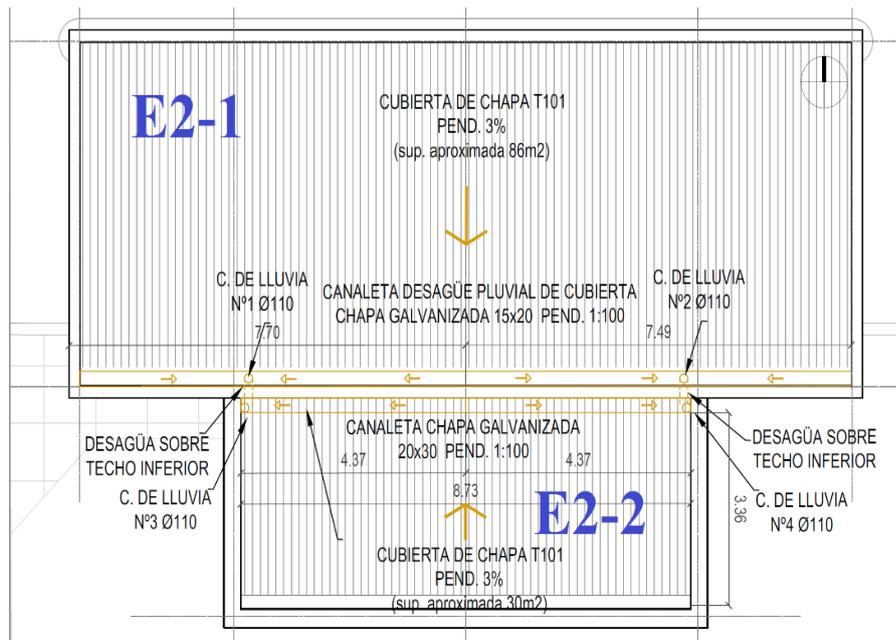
Planta de techos, Edificio E2 a desaguar en paso fronterizo La Quiaca - Provincia de Jujuy
